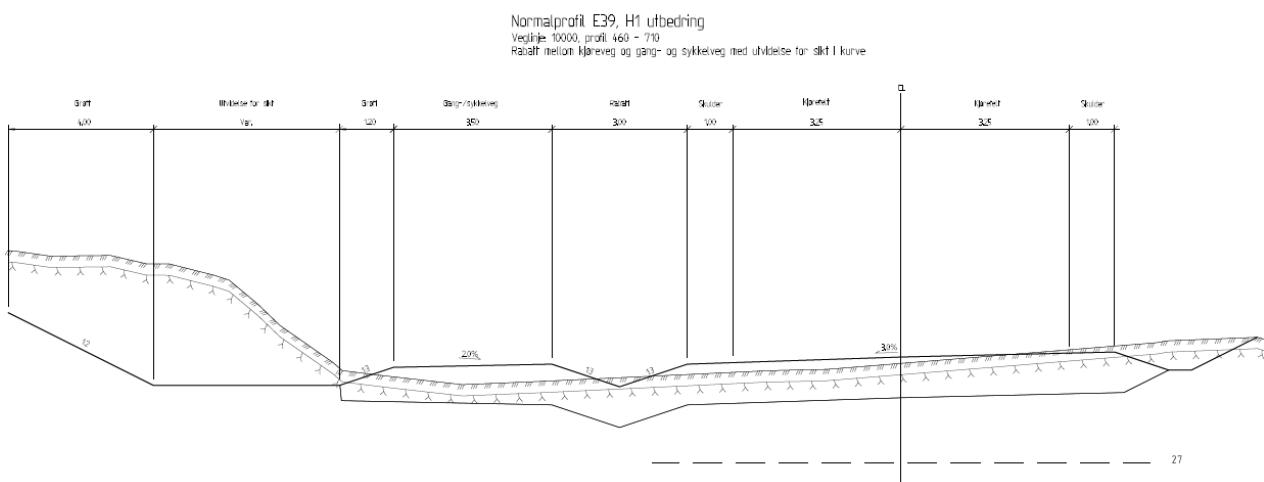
Tverrprofil frå handbok N100 for H1 utbetring, 80 km/t.
